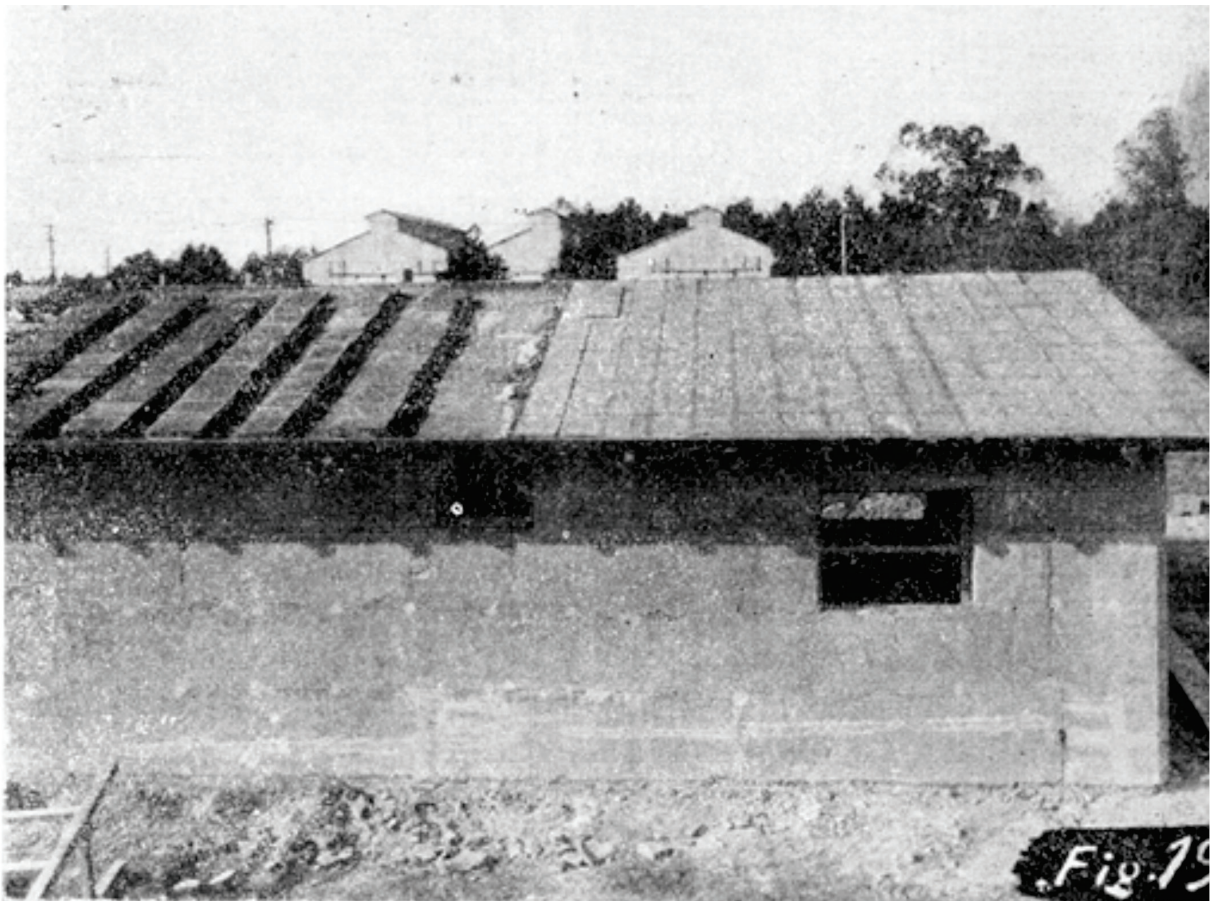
Vivienda en construcción, donde se observa el montaje de las losetas de la cubierta.
